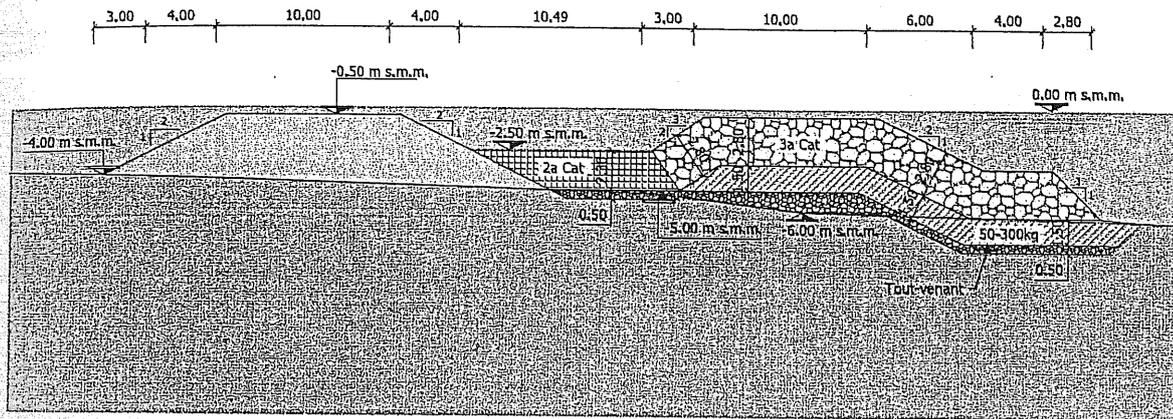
Sezione tipo del rinforzo della barriera soffolta centrale.
